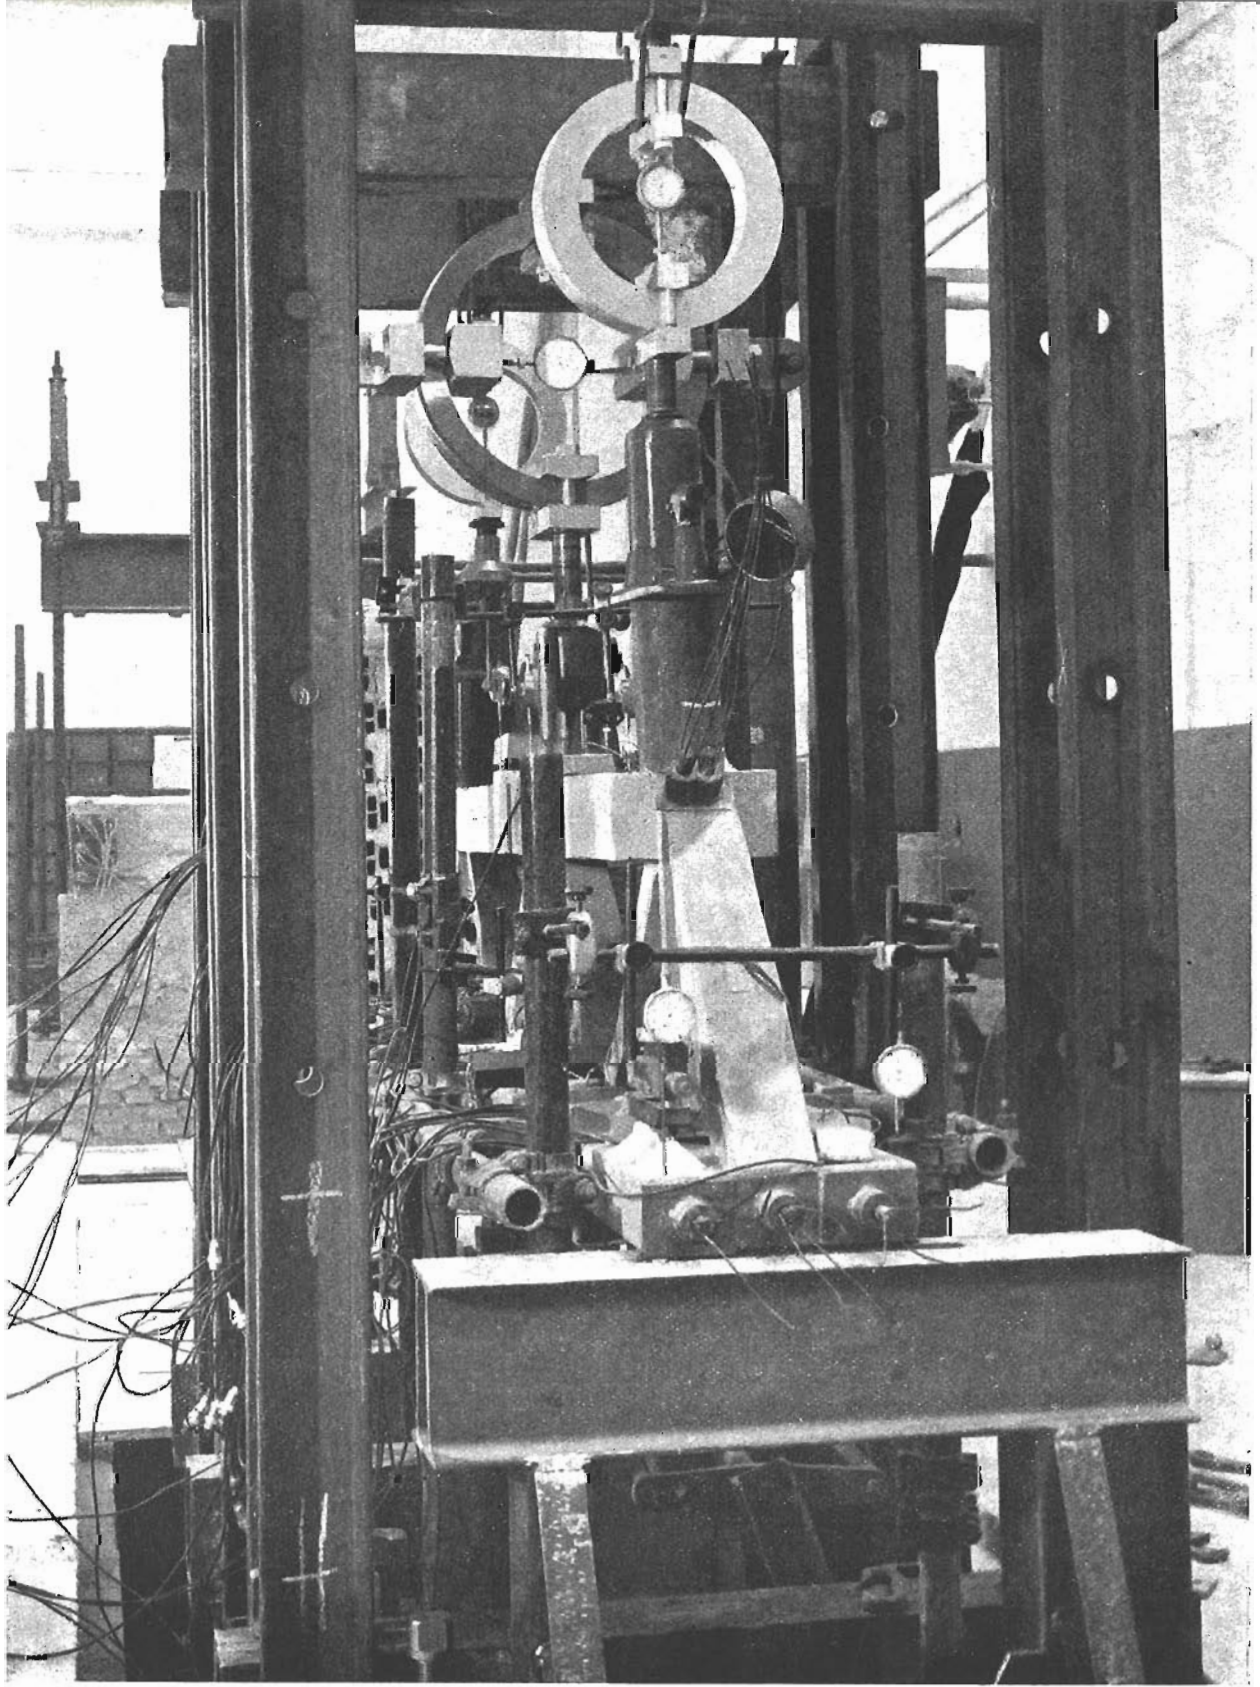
Dispositivo de ensayo de una viga. (Puente de La Baells.)
